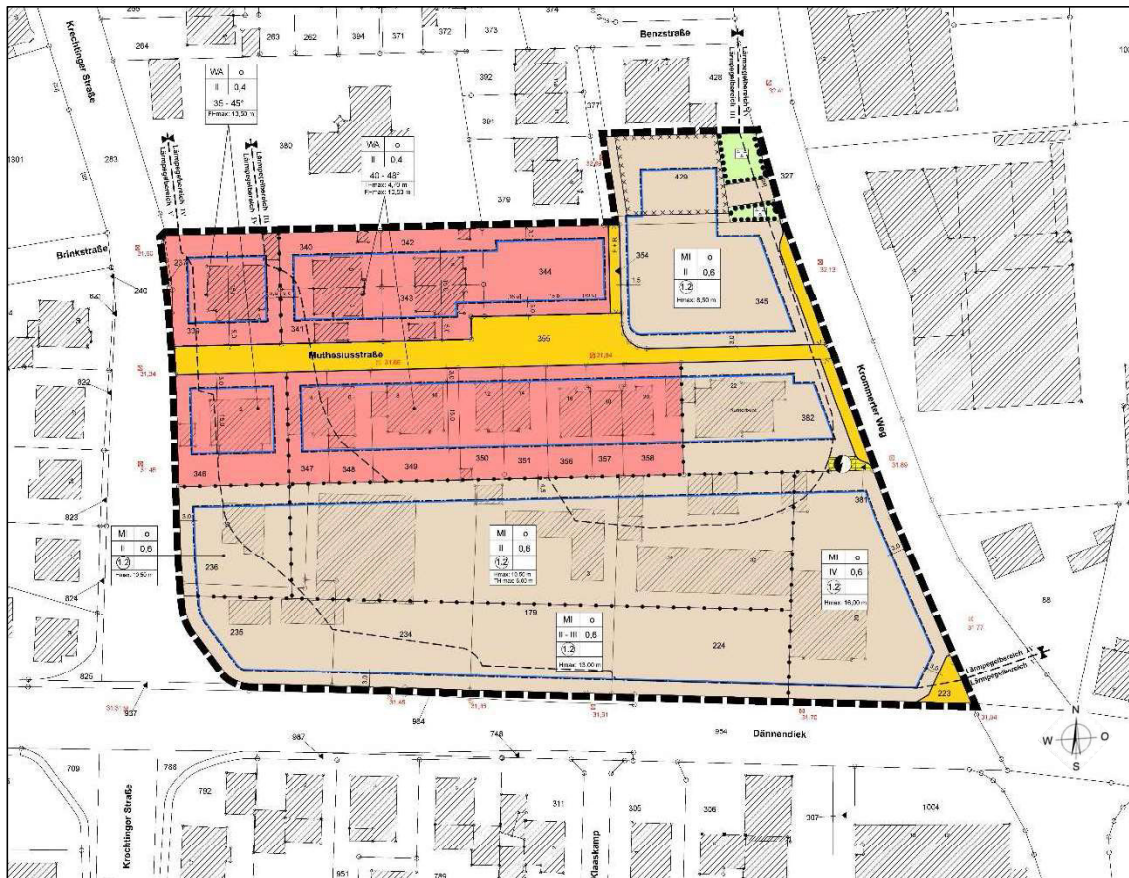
Planzeichnung zum Bebauungsplan /7/
